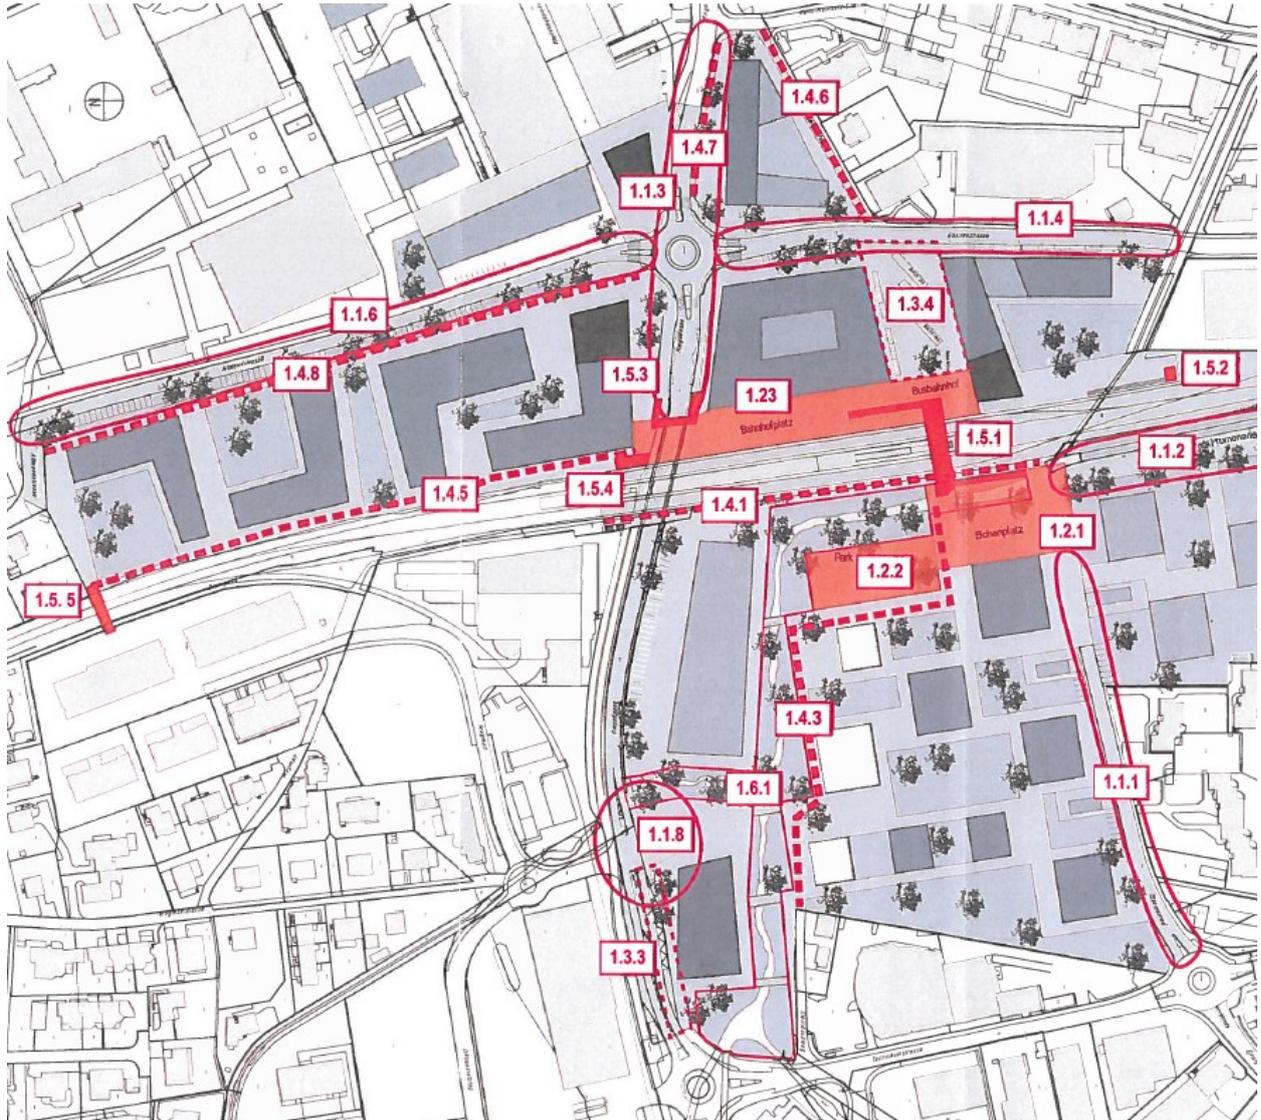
Einzelne Infrastrukturelemente im Bebauungsplan
